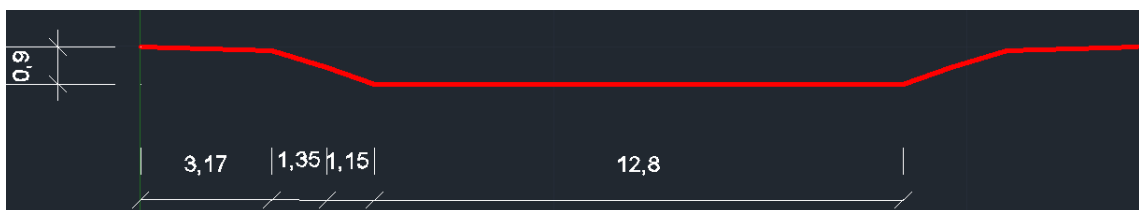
Detalle de la sección transversal de la zanja en Autocad
